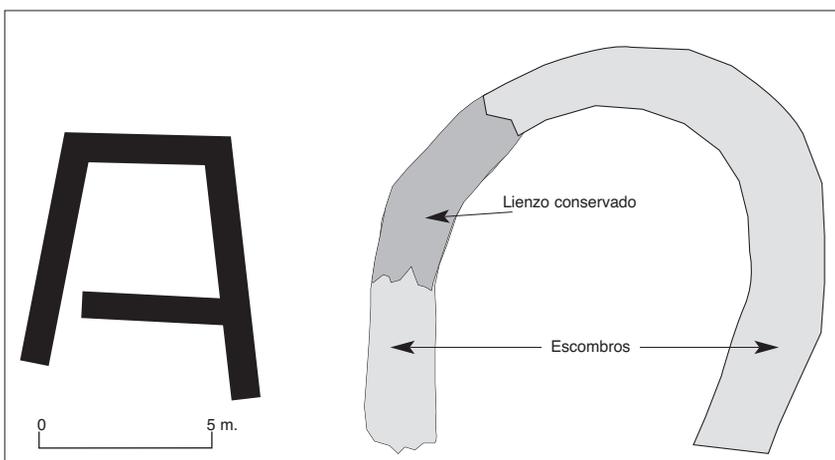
Planta de la atalaya del cerro de San Blas (Ágreda).
